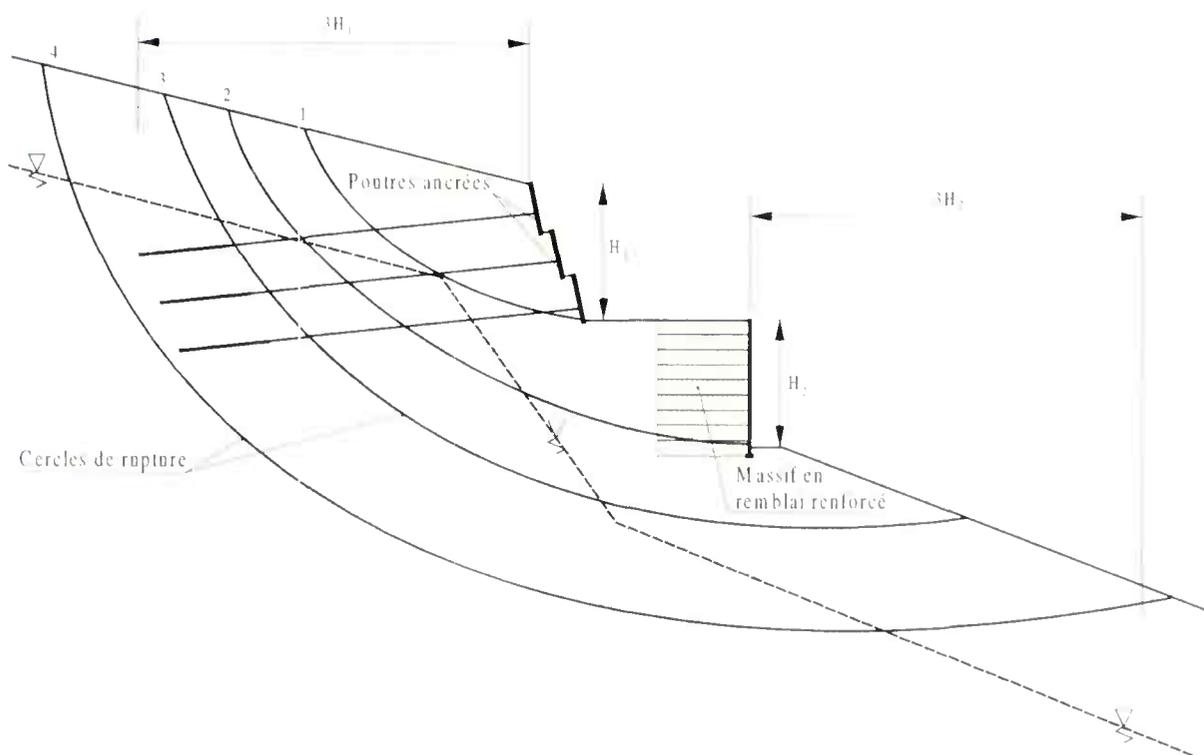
Stabilité générale des ouvrages sur versant
